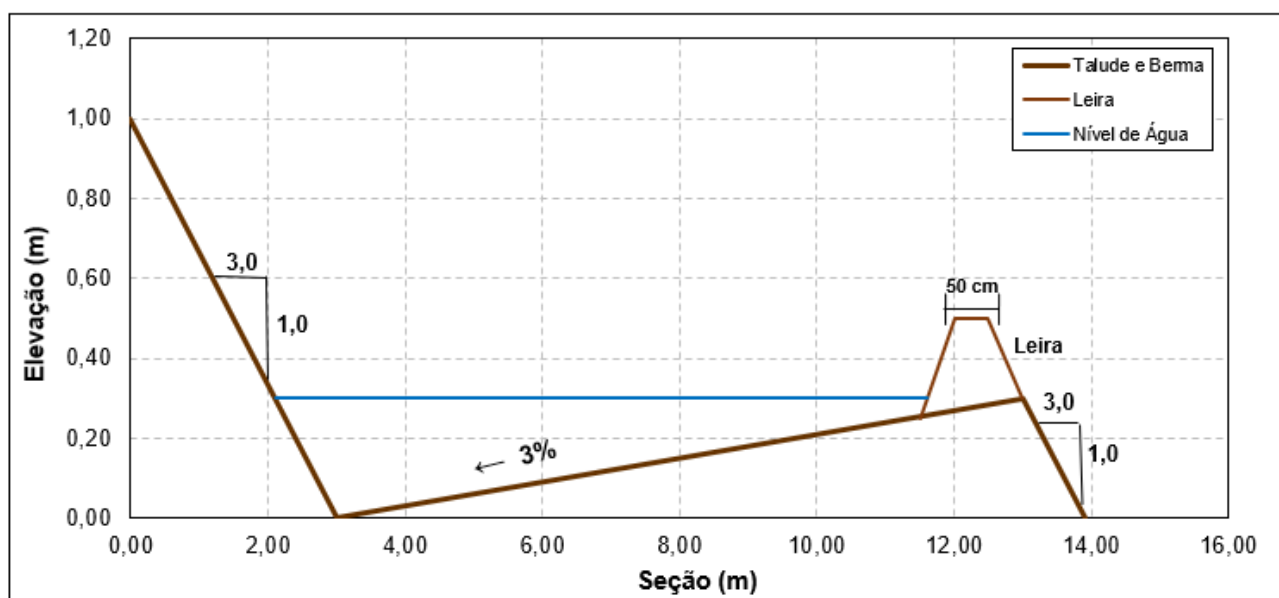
Croqui esquemático das bermas das Pilhas
